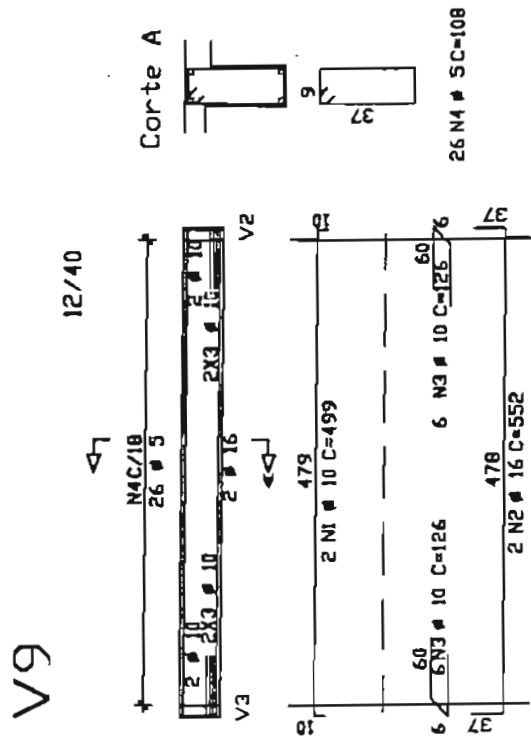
Detalhe de armadura da viga V9 (pórtico simplificado)
